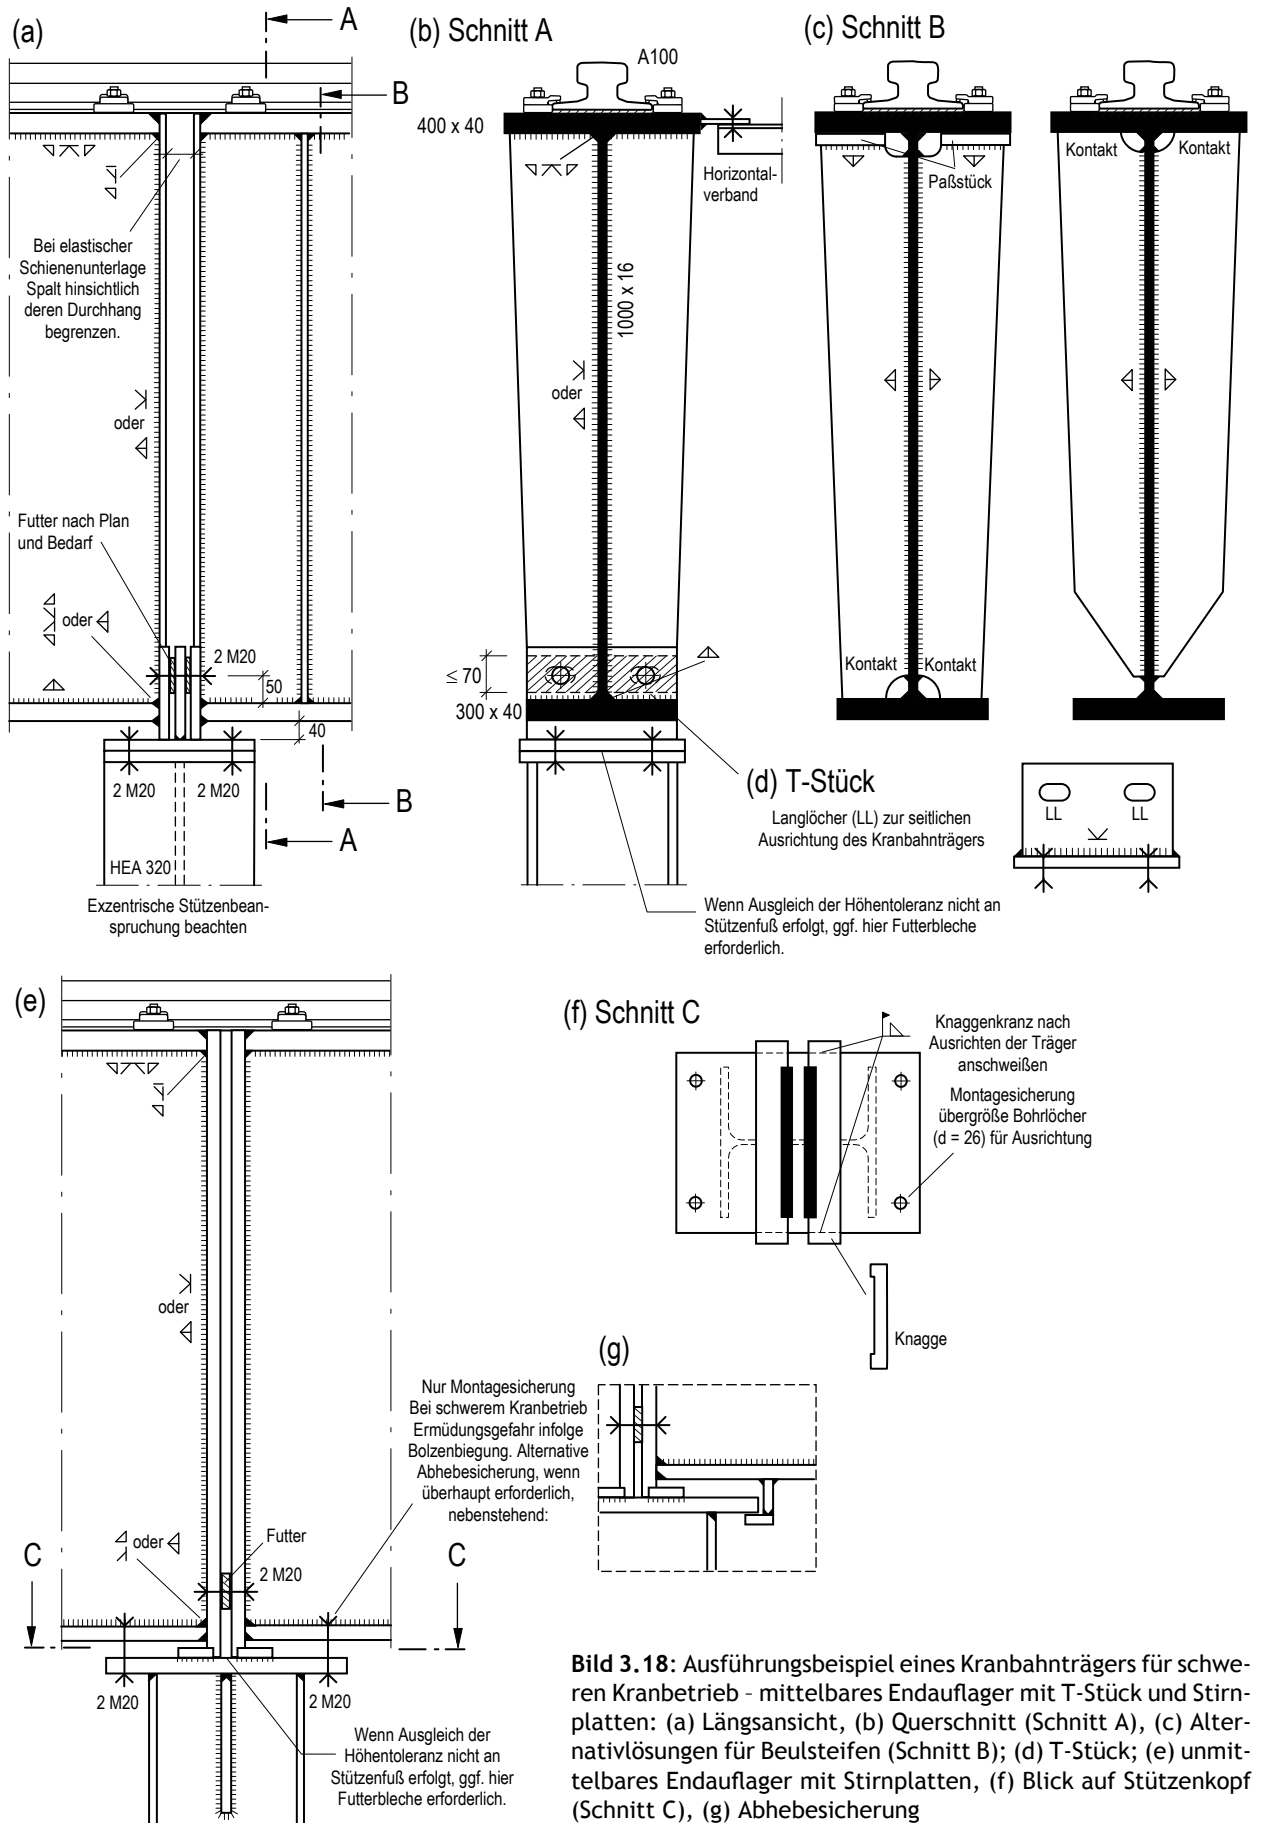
Ausführungsbeispiel eines Kranbahnträgers für schweren Kranbetrieb - mittelbares Endauflager mit T-Stück und Stirnplatten: (a) Längsansicht, (b) Querschnitt (Schnitt A), (c) Alternativlösungen für Beulsteifen (Schnitt B); (d) T-Stück; (e) unmittelbares Endauflager mit Stirnplatten, (f) Blick auf Stützenkopf (Schnitt C), (g) Abhebesicherung
